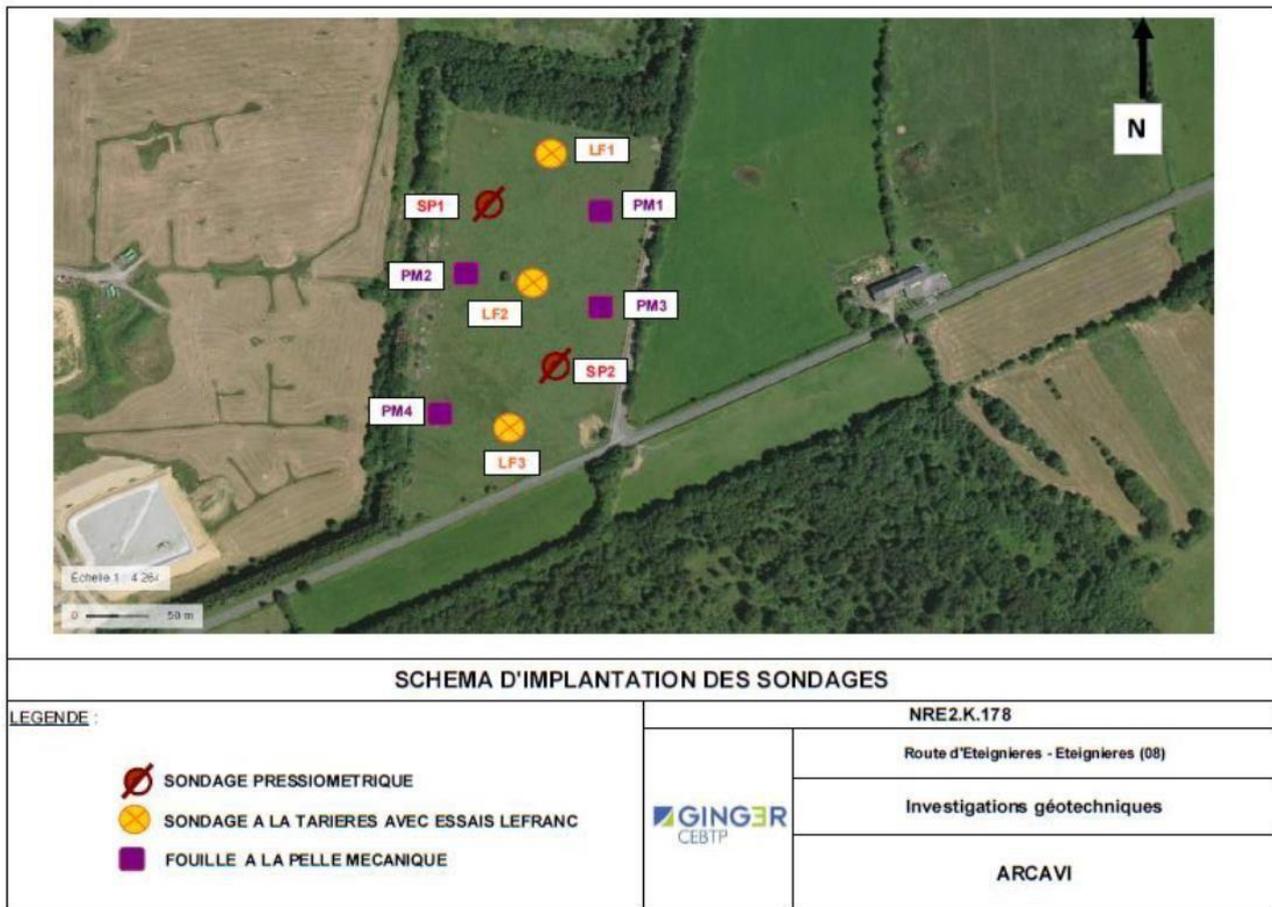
Implantation des reconnaissances au droit de la future extension (source : ARCAVI)
